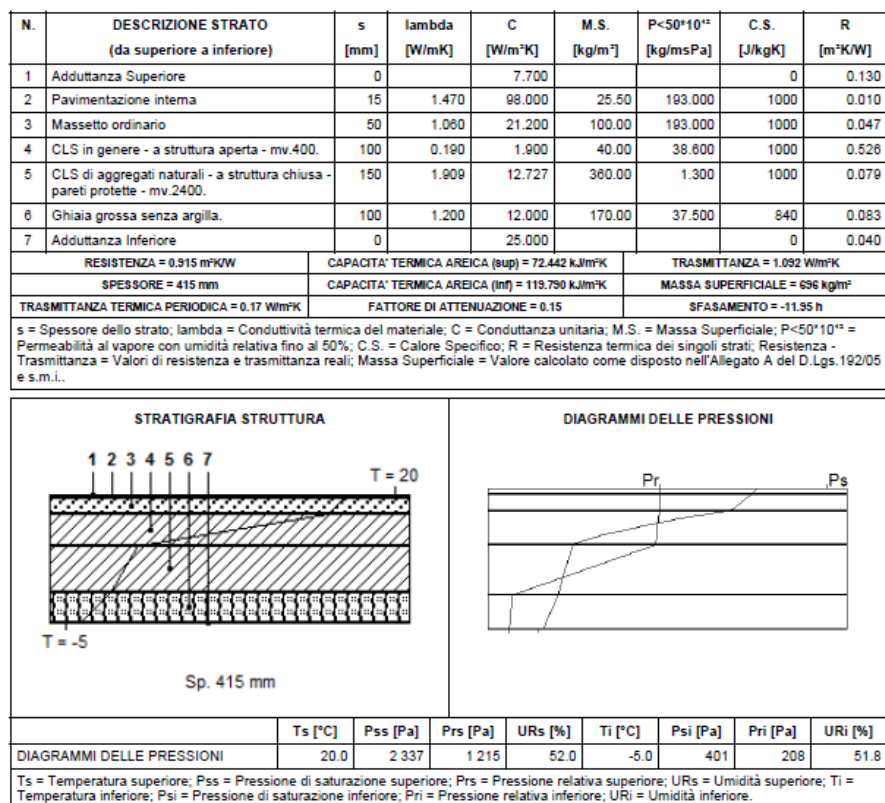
Descrizione struttura Pavimento controterra spessore 41,5 cm
